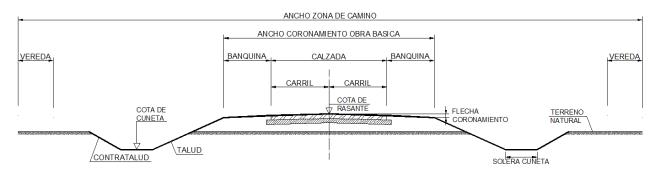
Perfil tipo rural (calzada bicarril indivisa)
